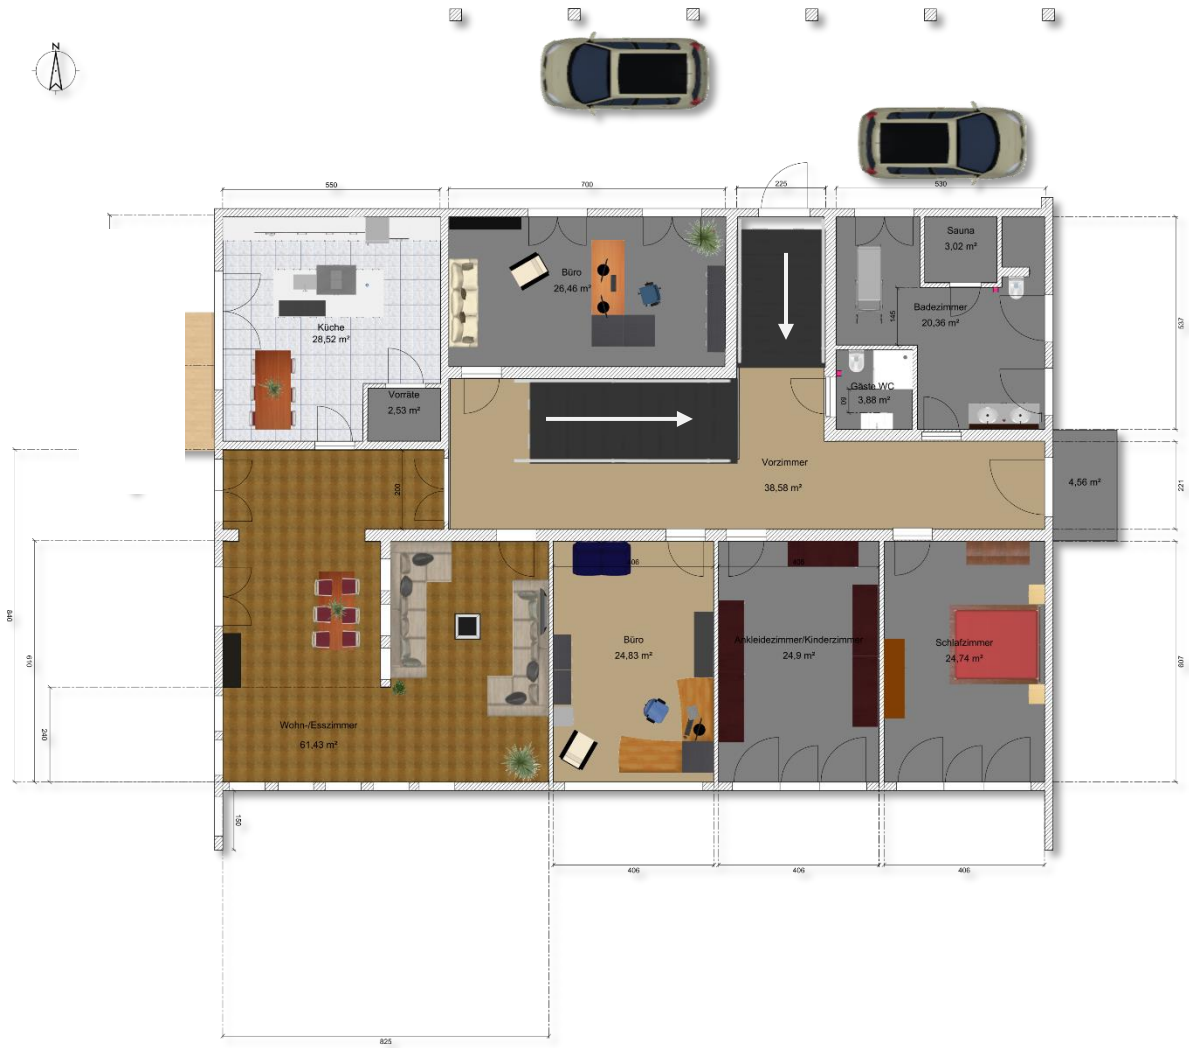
Grundriss Erdgeschoss nach Adaptierung
